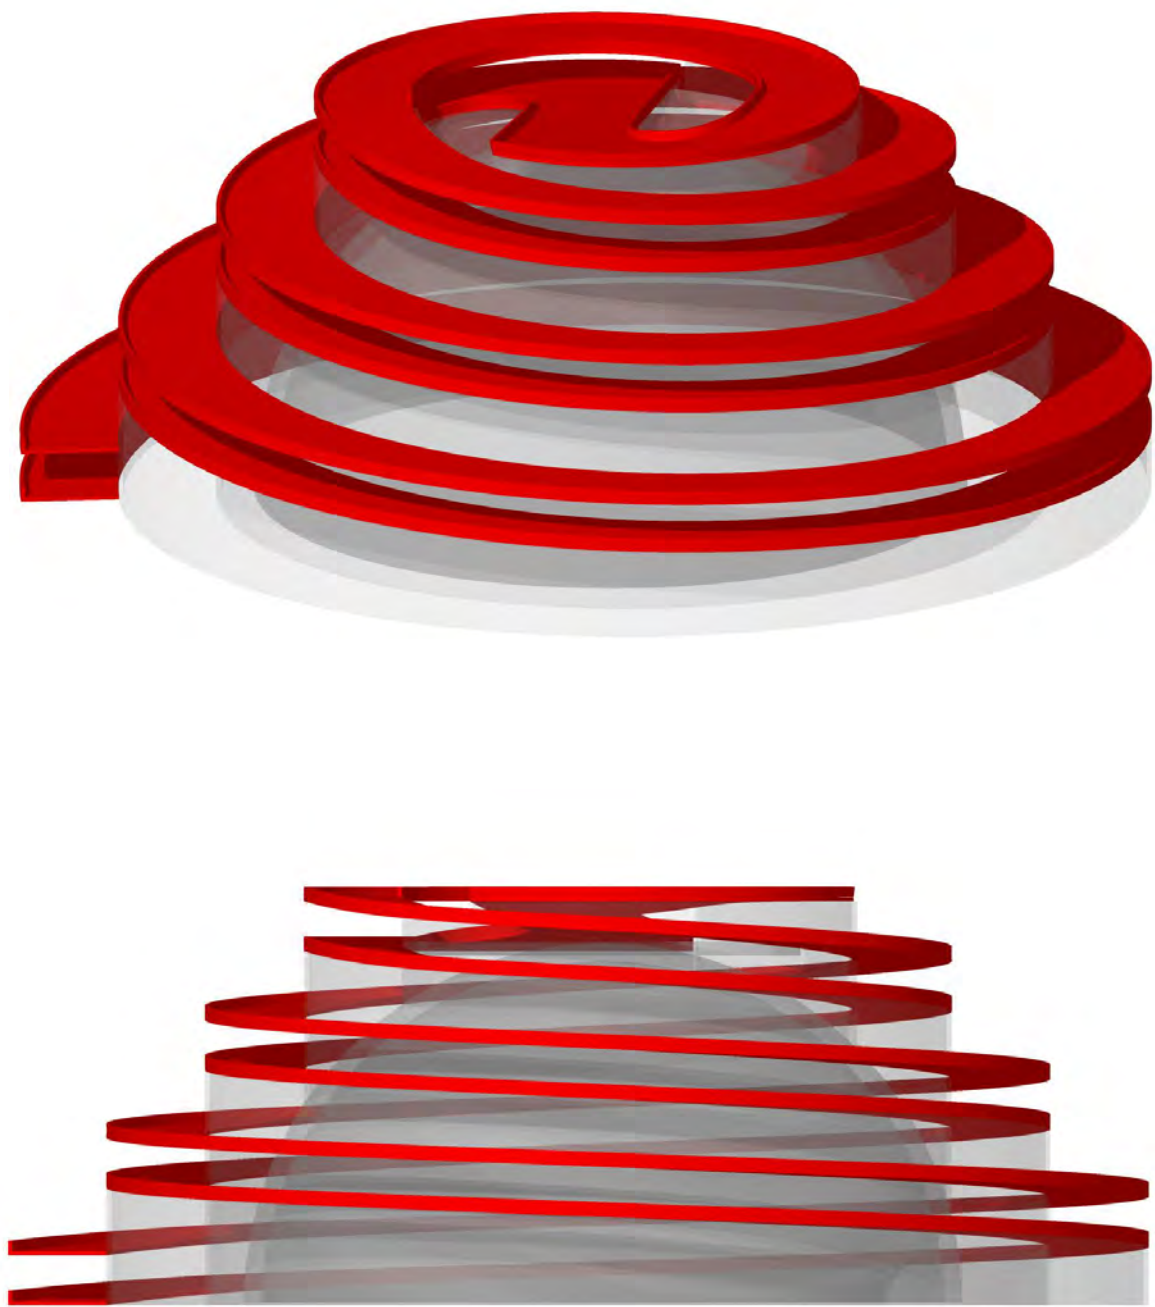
In alto vista prospettica, in basso vista frontale con le rampe in evidenza
